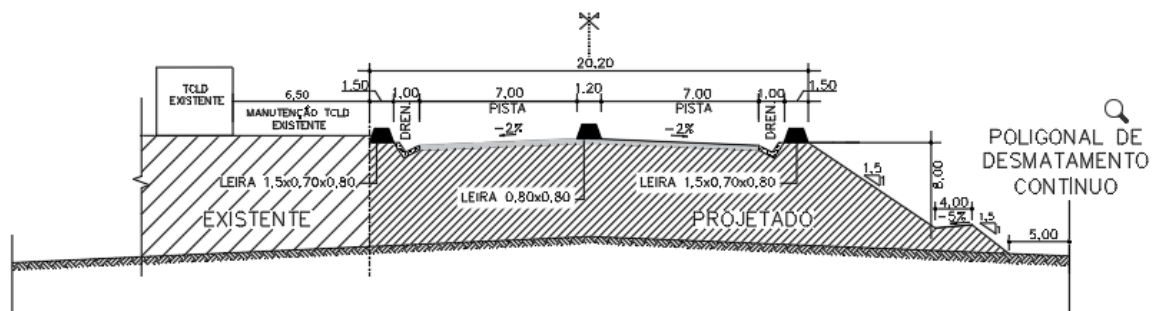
Vista da Seção Tipo Projetada da estrada – SEÇÃO DE ATERRO
